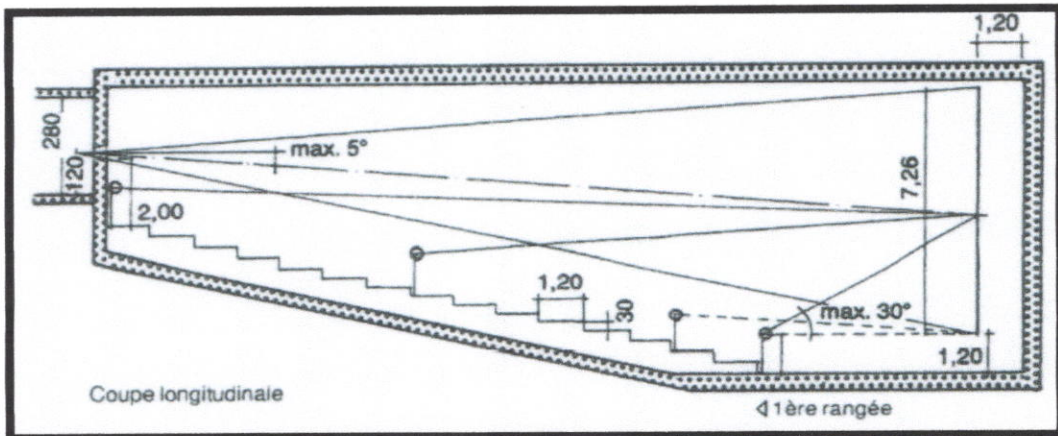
coupe longitudinale d'une salle, source : Neufert 7^e édition.
